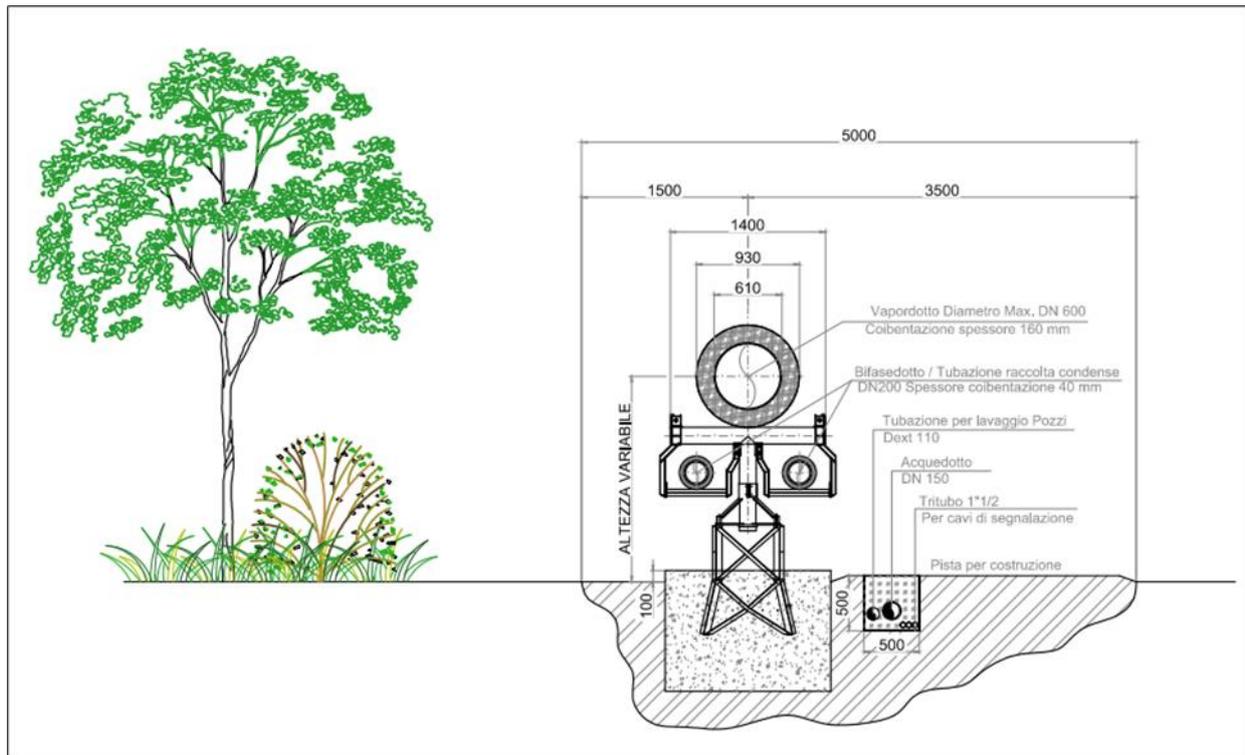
Tipico posa rete fluidi (caso con pista di costruzione)
